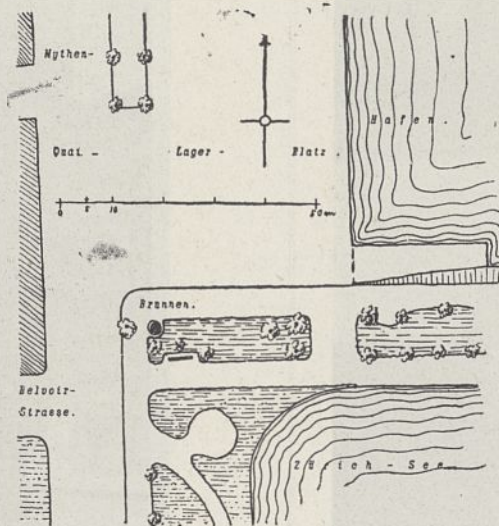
Zürich, Mythenkai mit Fischerbrunnen. Lageplan.
